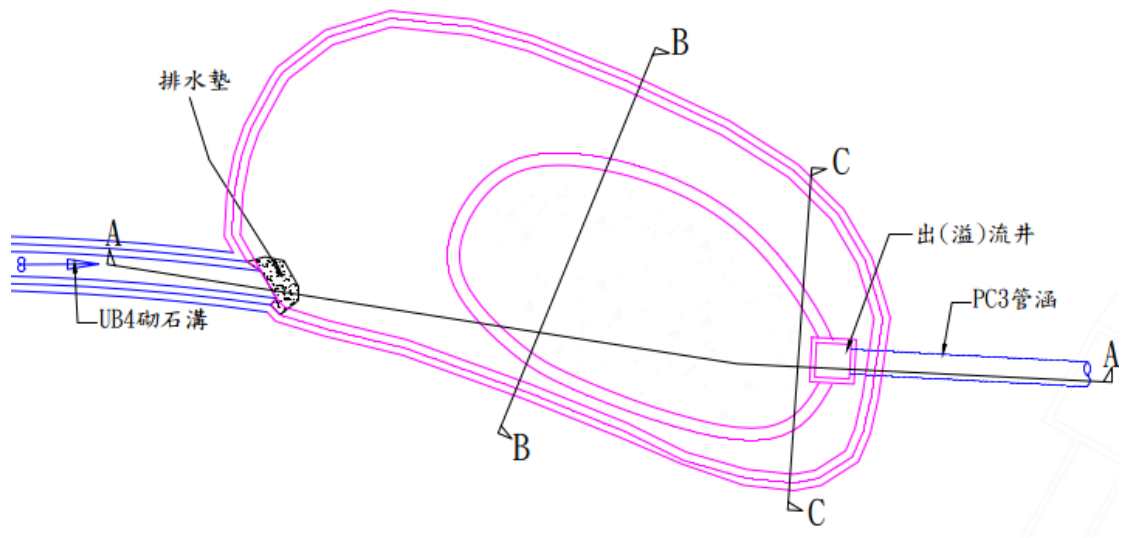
水庫防淤 - DET1 滯洪沉砂池平面圖
